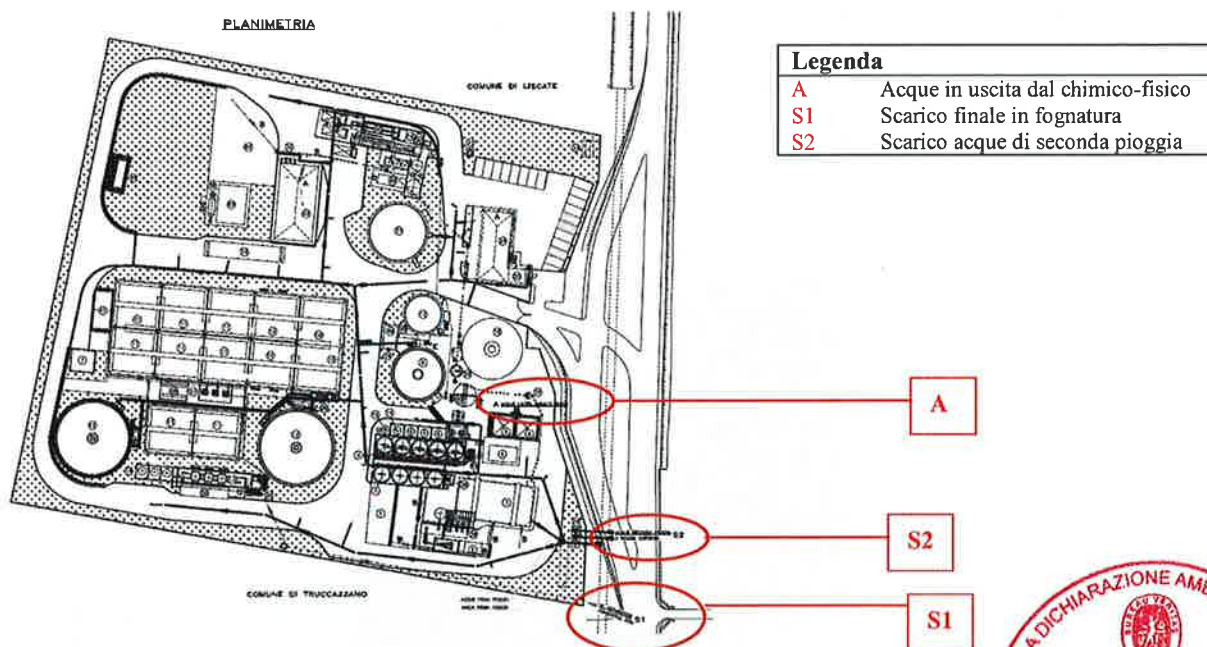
Planimetria dell'impianto con evidenza dei punti A, S1 e S2
